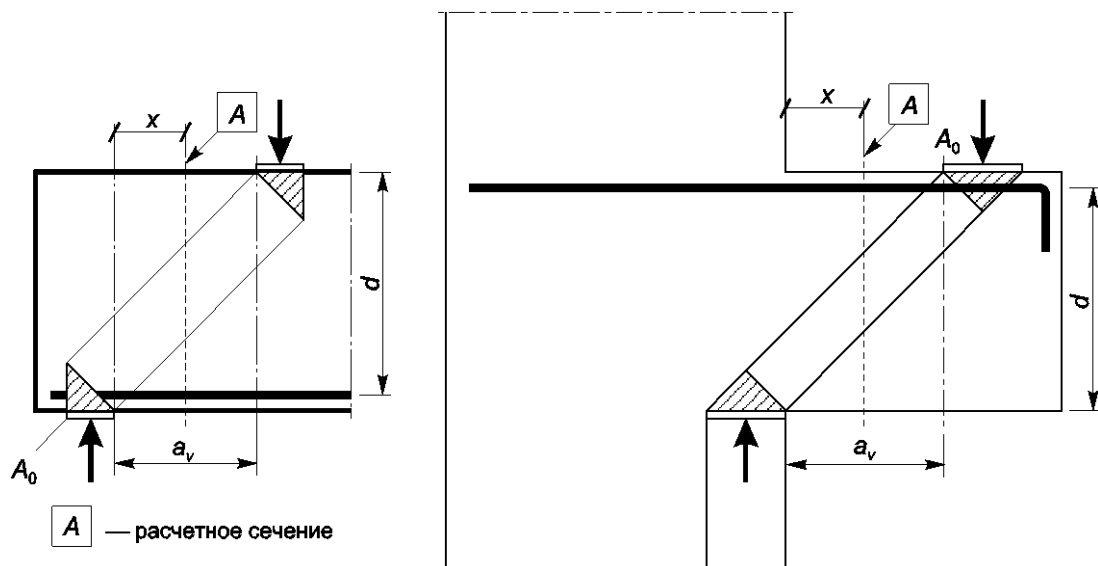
К расчету коротких балок и консолей, не имеющих поперечной арматуры
